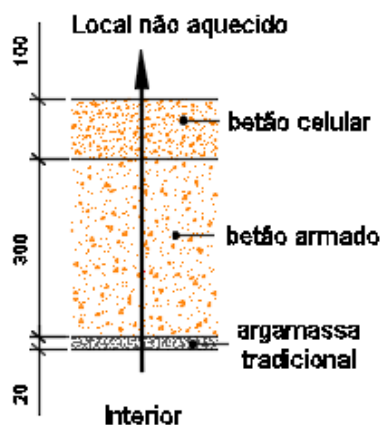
Pormenor da cobertura da envolvente exterior – COB 1
